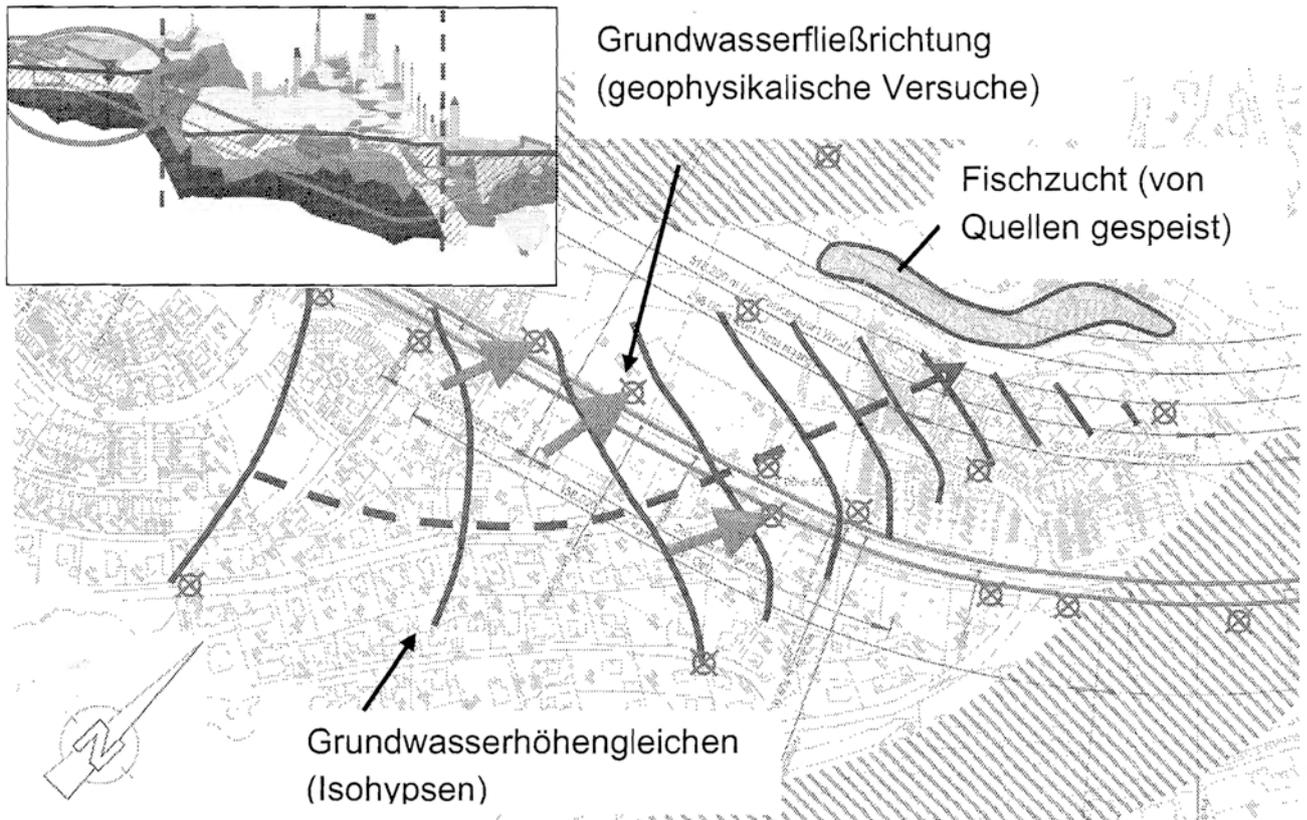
Grundwasserabschnitt 1, südlicher Tunnelabschnitt
